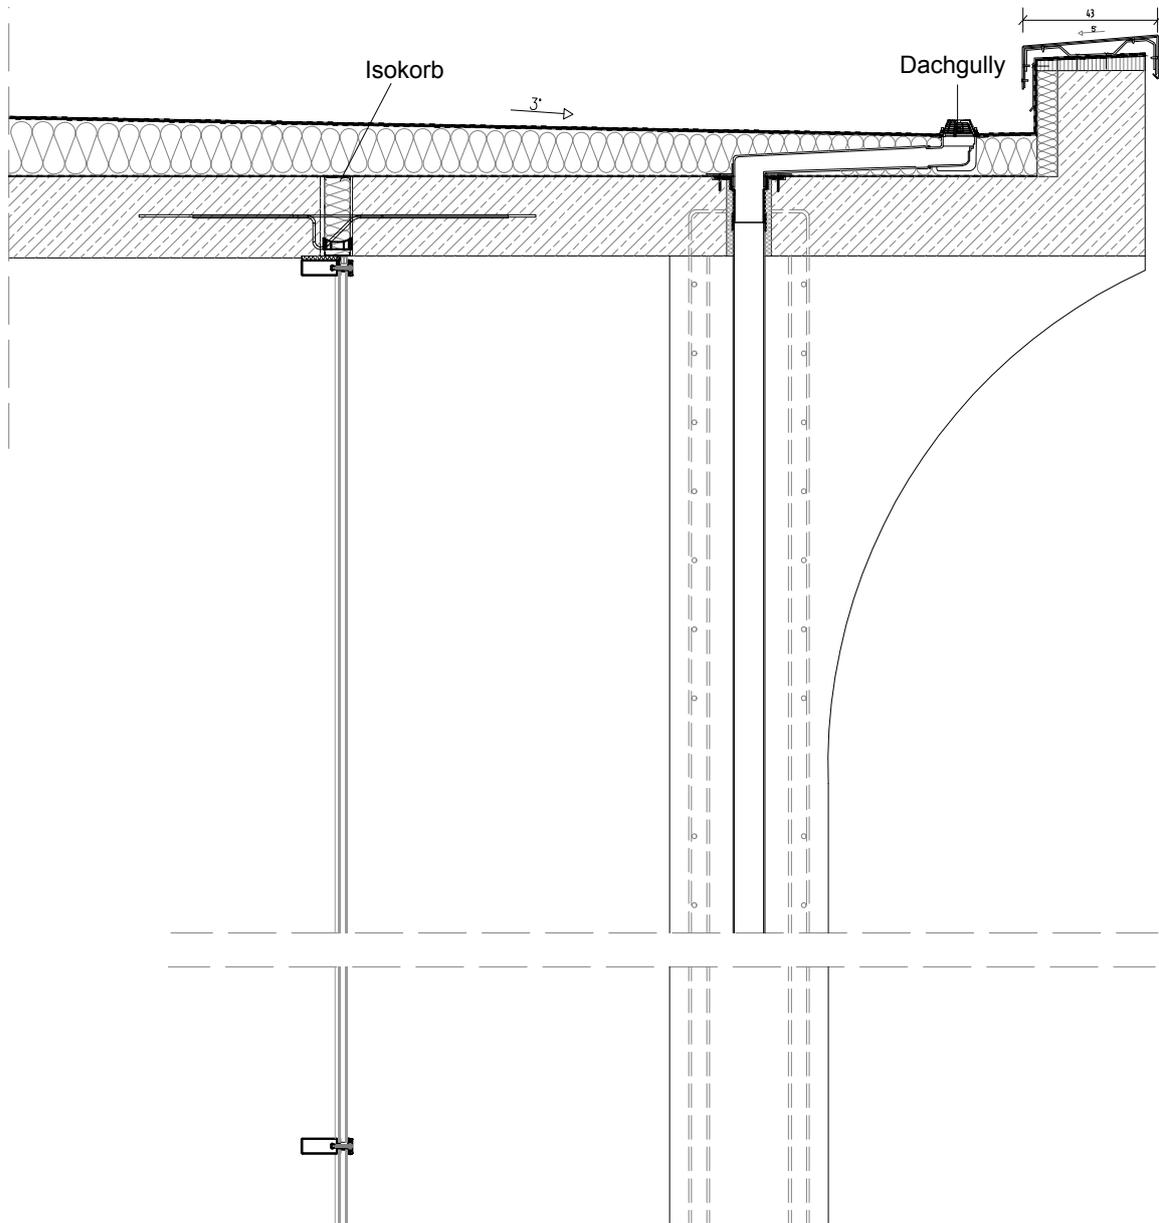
Detaillierte Fassadenschnitt | M: 1:25
